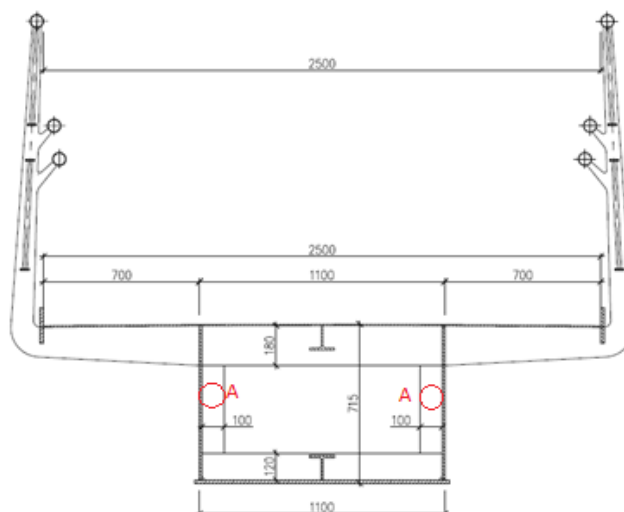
Secção transversal da ponte pedonal com concepção de viga em caixão, com indicação dos reforços transversais das almas [24].
